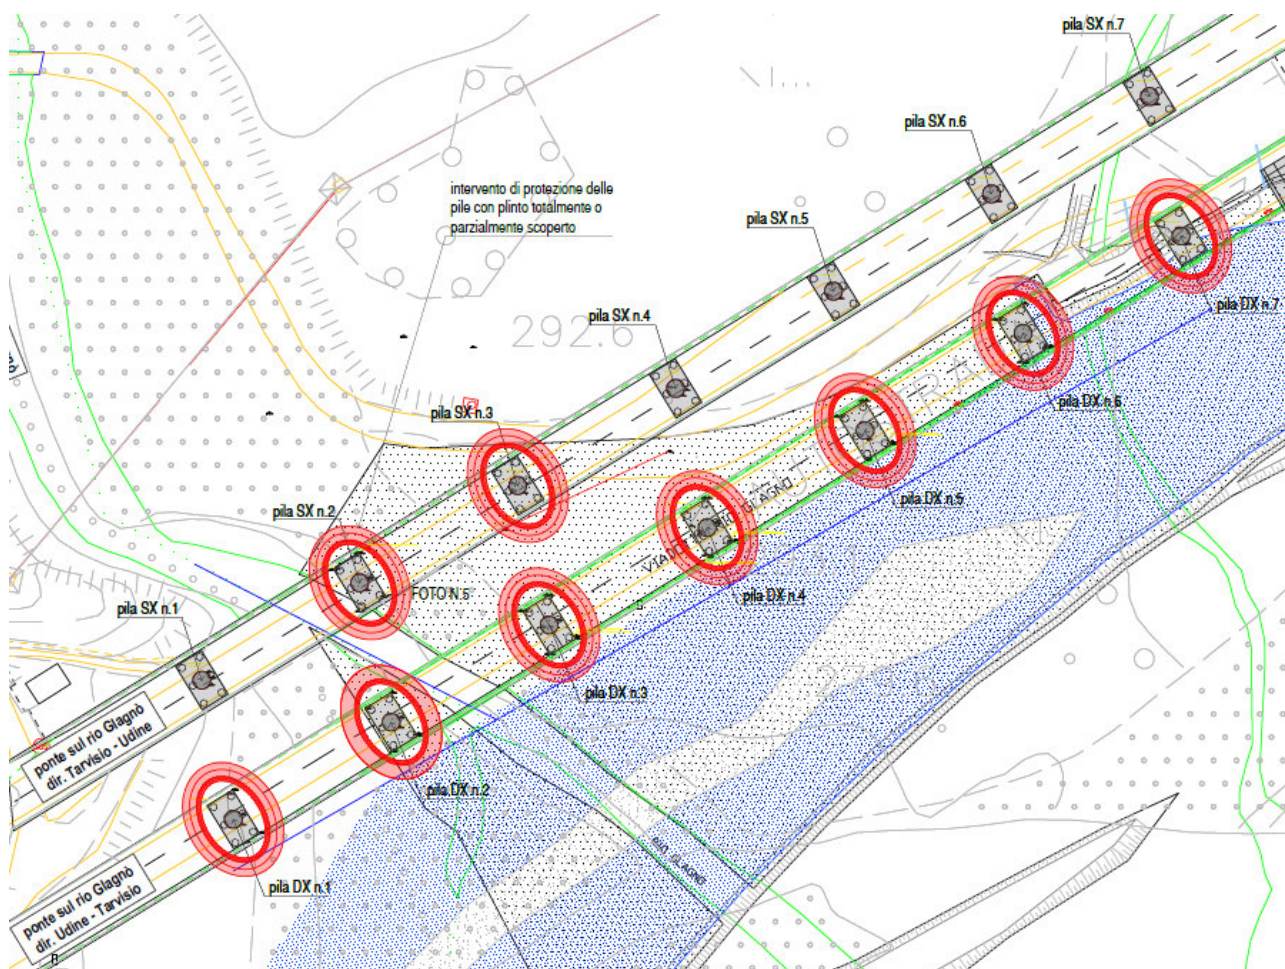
Estratto di planimetria di progetto con indicazione della numerazione delle pile e del flusso principale del Rio Glagnò e del Fiume Fella.
